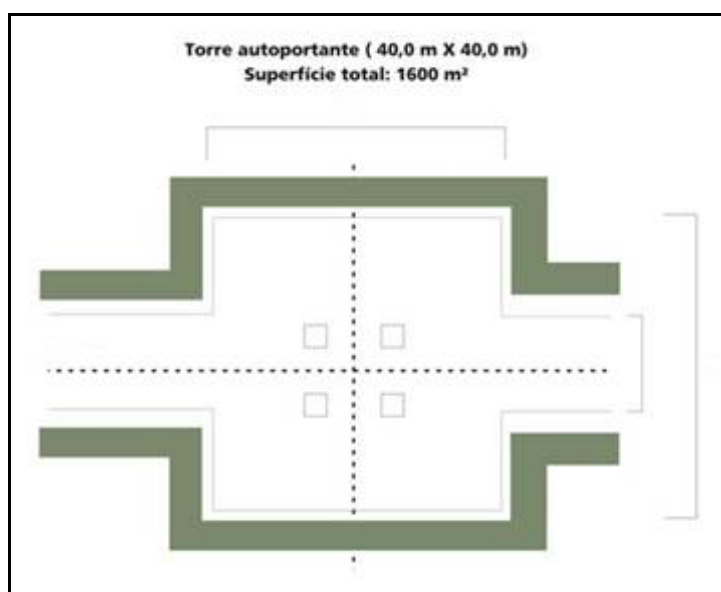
Croqui de supressão para implantação de torre autoportante.
